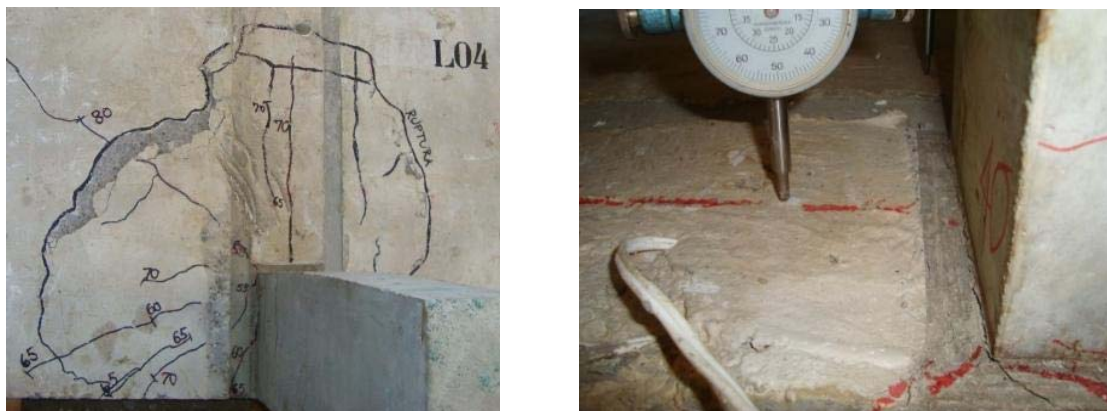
Padrão de fissuração do modelo L04
